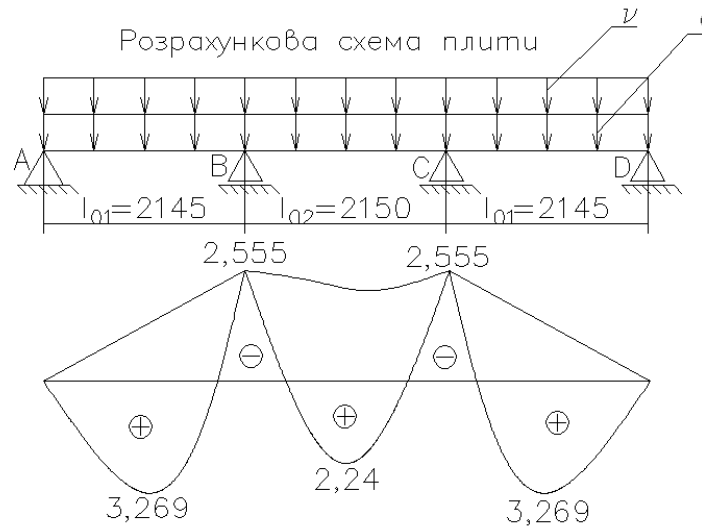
Розрахункова схема та еюра згинальних моментів плити
